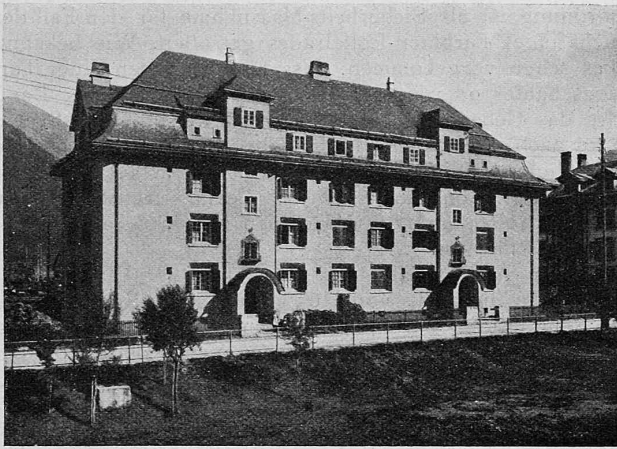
Strassenfront (N-W) eines Wohnhauses für 4x3 Familien der Rhät. Bahn in Samaden. — Abb. 2. Grundrisse dazu, 1:400.
